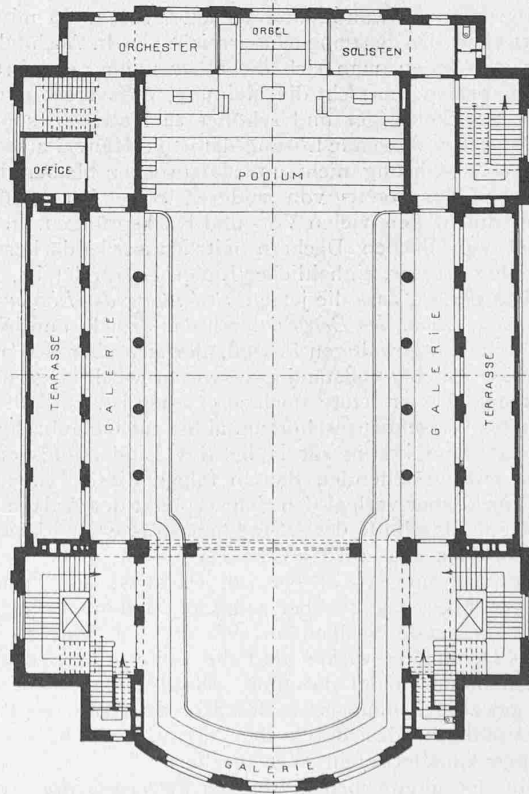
Grundriss vom Galeriegesschoss. Masstab der Grundrisse 1 : 400.
